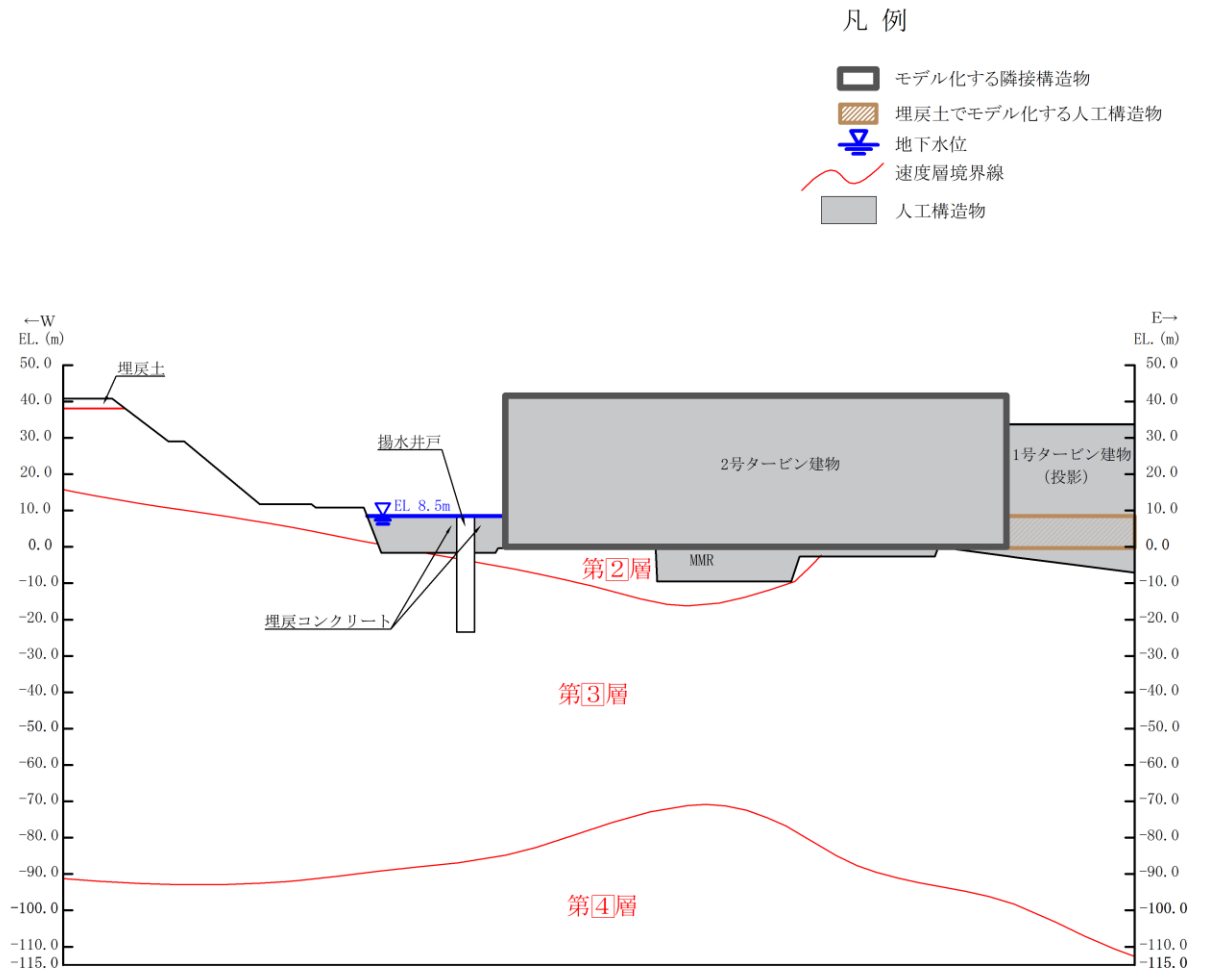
評価対象断面図 (A-A 断面 (東西方向))
